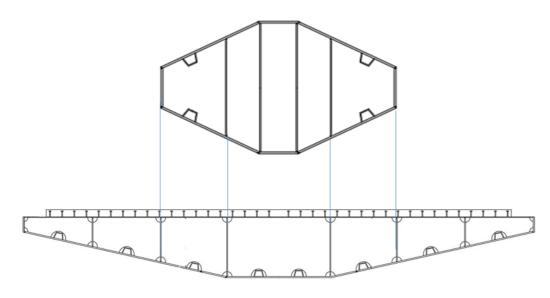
Secciones con detalles estructurales (Fuente: Propia)
